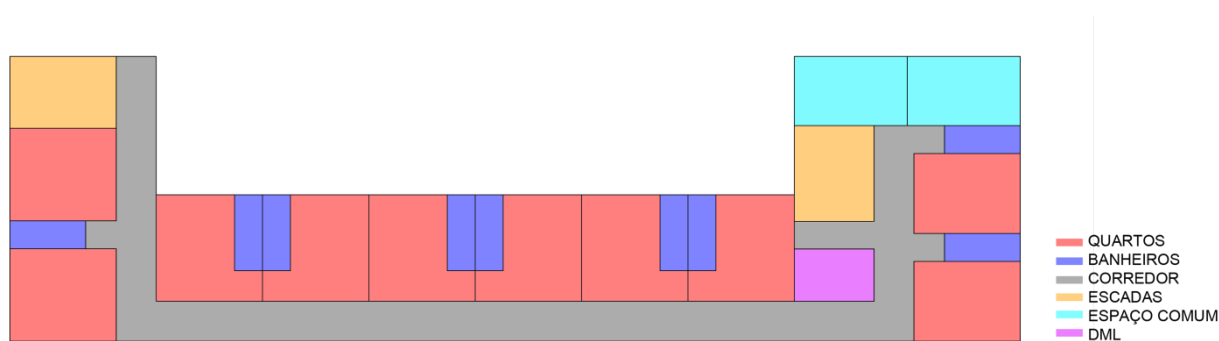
Planta pavimento tipo CENIBRAC. Fonte: (AUTORA, 2014)
